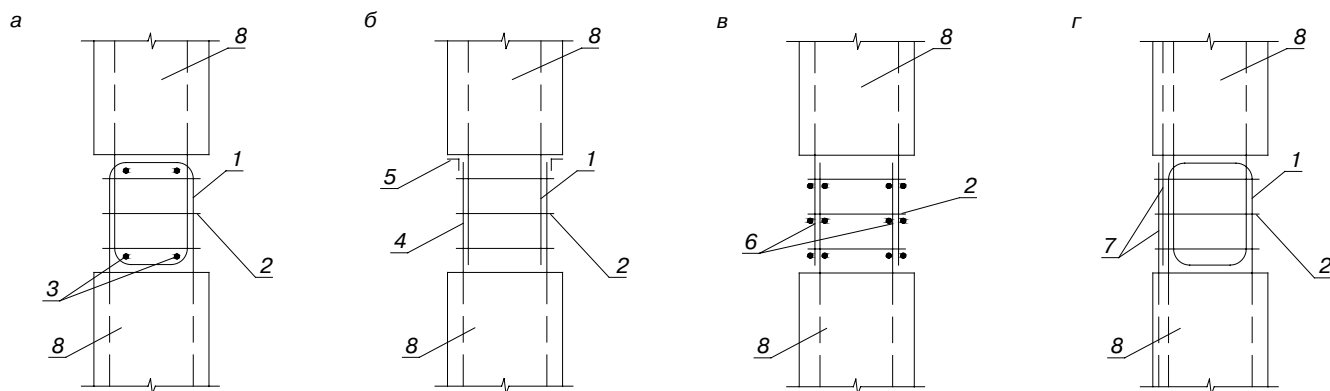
Армирование стыка сборных колонн в узлах каркасных систем: а – петлевой стык внахлестку; б – стык петлевых и стержневых выпусков; в – стык внахлестку плоских арматурных каркасов; г – стык петлевых выпусков с дополнительной продольной арматурой; 1 – петлевой выпуск рабочей арматуры; 2 – хомуты; 3 – анкерующие стержни; 4 – стержневые выпуски рабочей арматуры; 5 – анкерующий уголок; 6 – выпуски плоских каркасов рабочей арматуры; 7 – дополнительная арматура; 8 – сборная колонна
